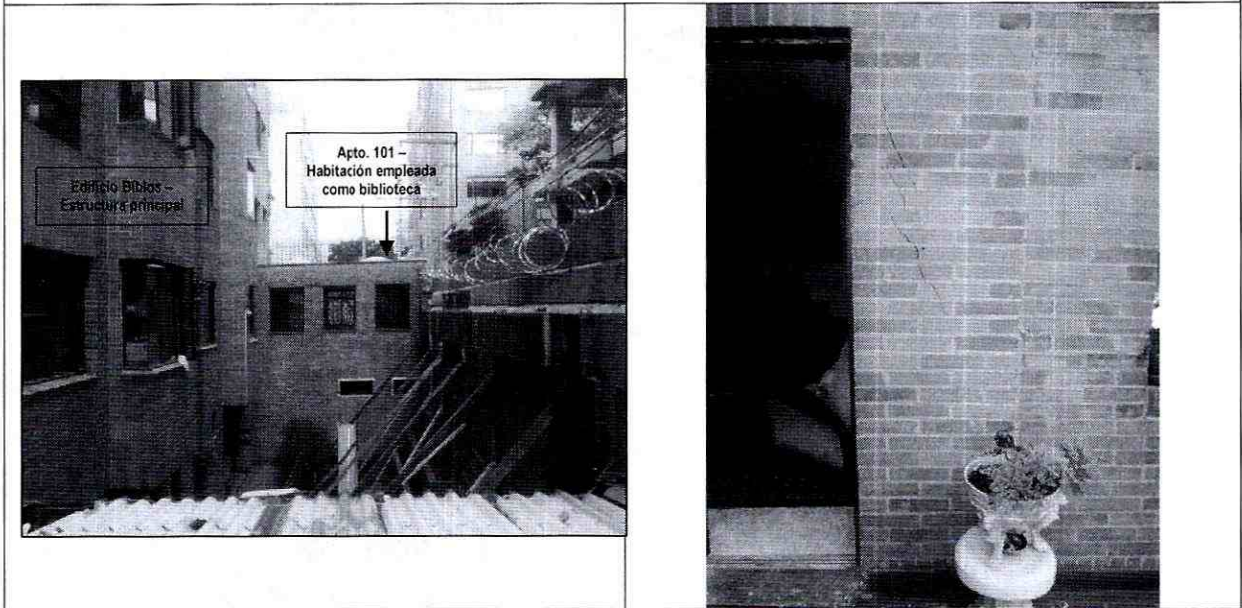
y 4: Vista de la construcción que se viene adelantando en el costado norte del Edificio Biblos No. 127 – 30, predio localizado en la Carrera 14 A No. 127 B -30
